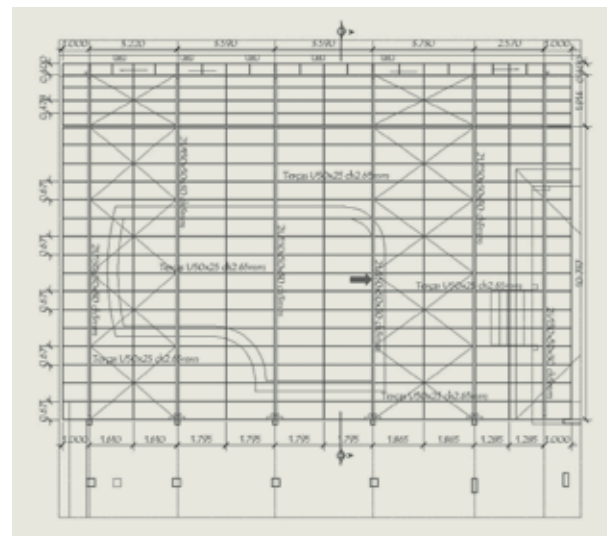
Planta da cobertura Terrasse Jardim com indicação do local de aplicação da carga nodal (Fonte: arquivo Projectação)
